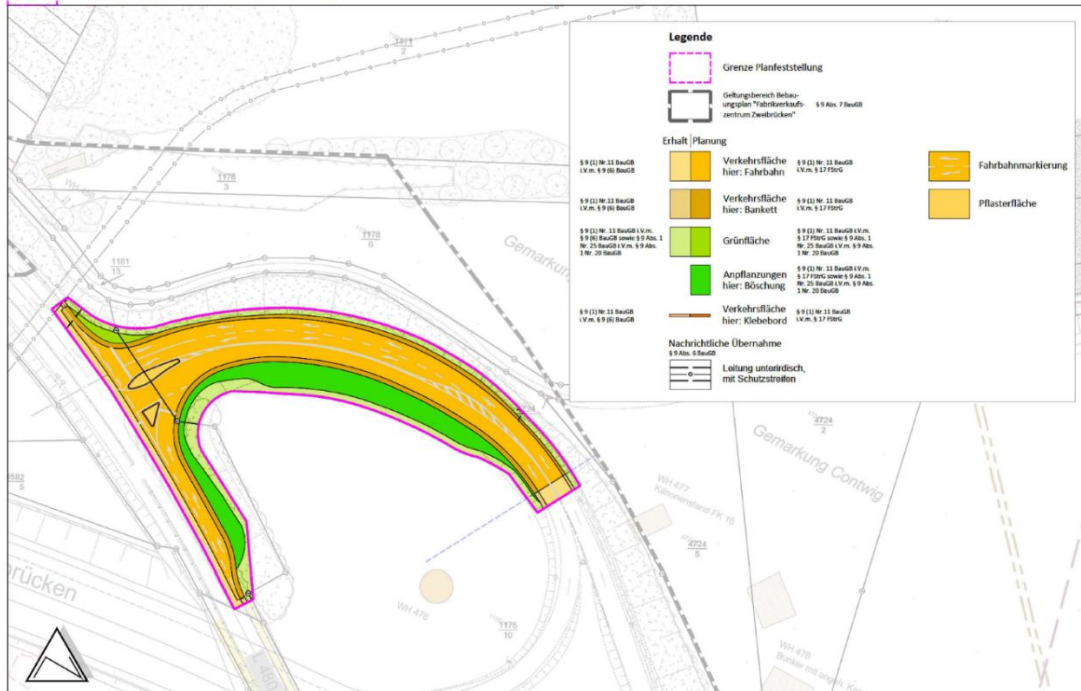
Zeichnerische Festsetzungen für den planfeststellungsersetzenden Teilbereich A „Knoten Nord“ unmaßstäblich, FIRU mbH auf Grundlage Schönhofen Ingenieure, 2025.
